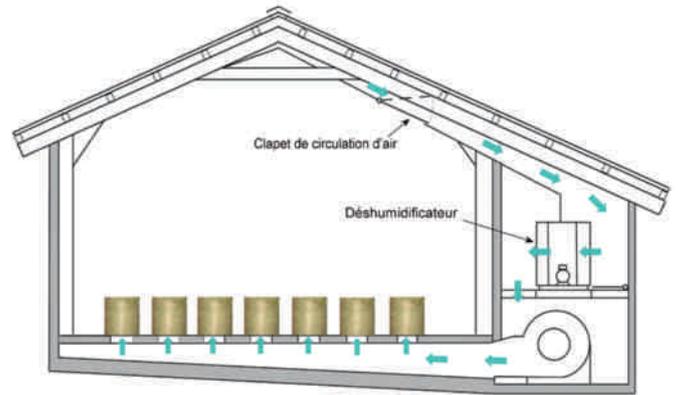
Schéma d'une installation de séchage de balles rondes dotée d'une ventilation par le bas et d'une aspiration en sous-toiture avec déshumidification de l'air.
